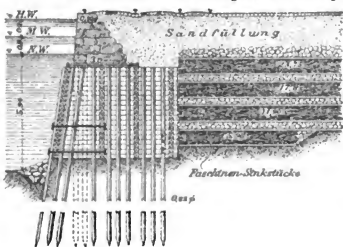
Hoher Pflahlrost mit Führungskasten. M. 1 : 250.
